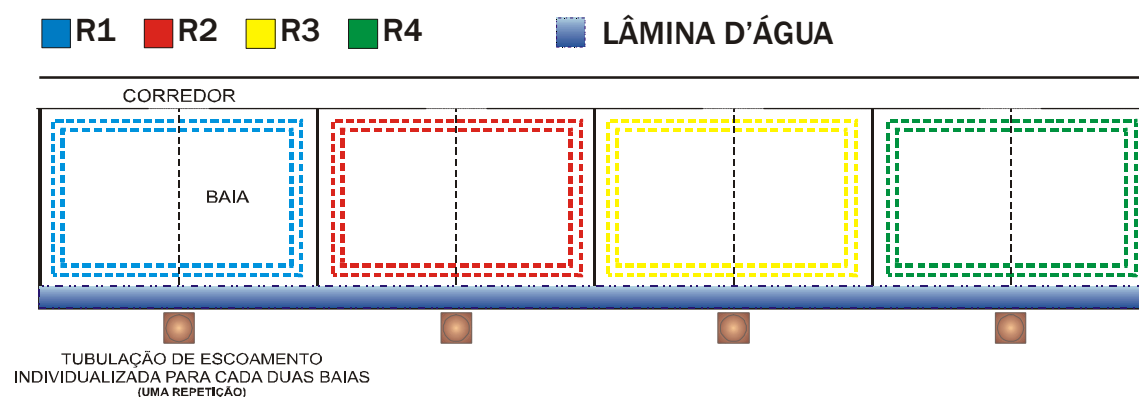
Croqui do barracão de recria com detalhes da instalação.
